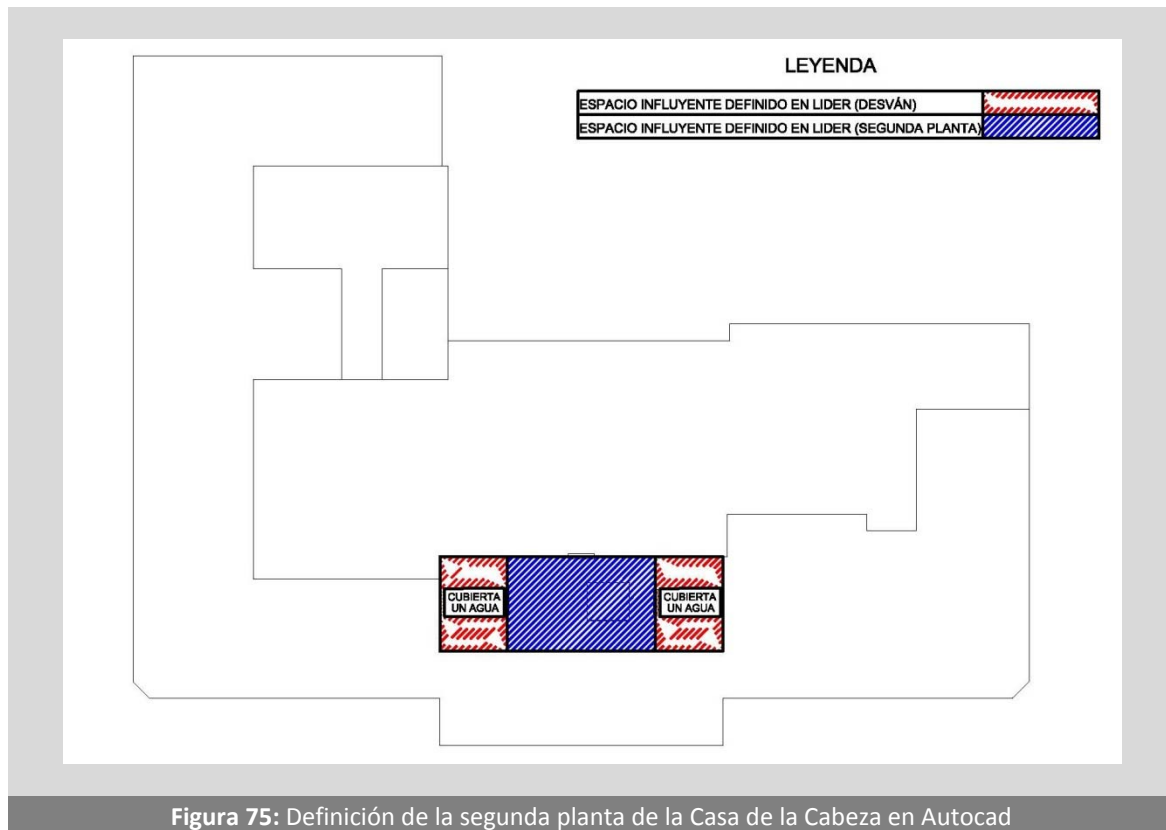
Definición de la segunda planta de la Casa de la Cabeza en Autocad
